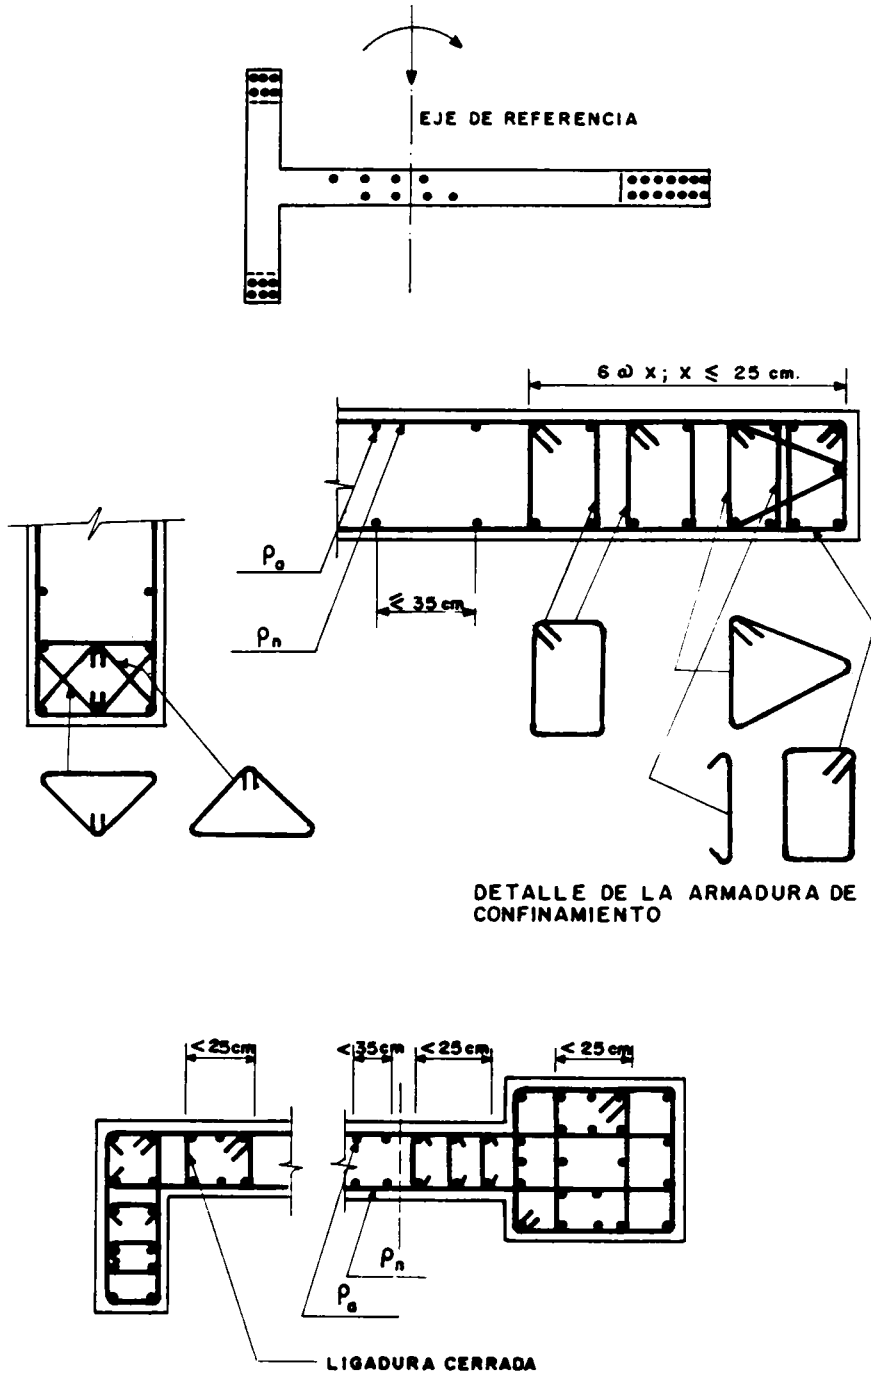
Ejemplos de disposición de armadura en un muro estructural.
